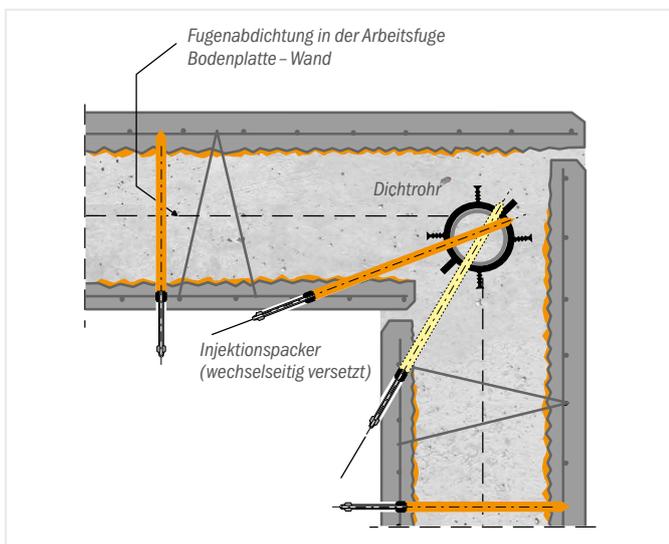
Nachträgliche Abdichtung einer Elementwanddecke mit Dichtrohr durch Injektion [7]
